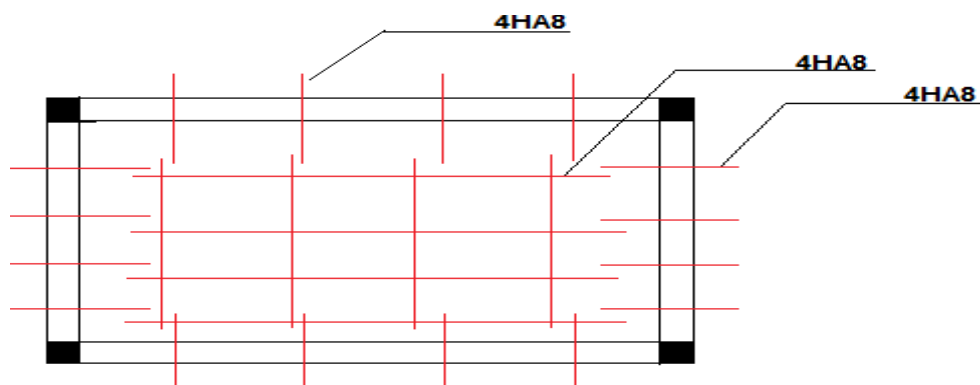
Schéma de ferrailage de la dalle sur quatre appuis.
